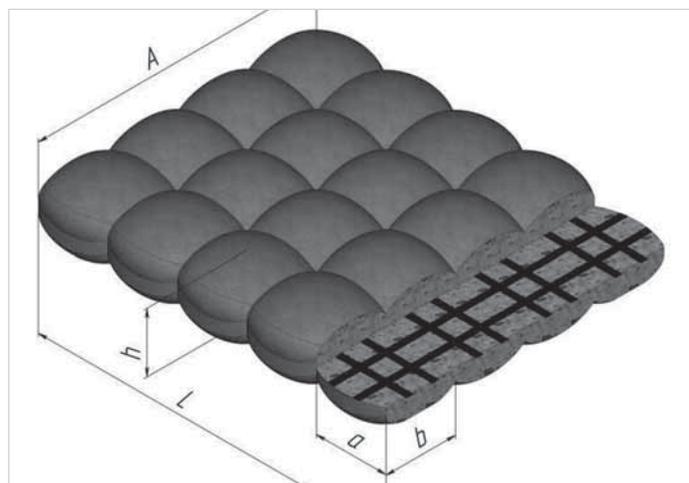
армированная цементирующая геооболочка БЕТОБОКС
